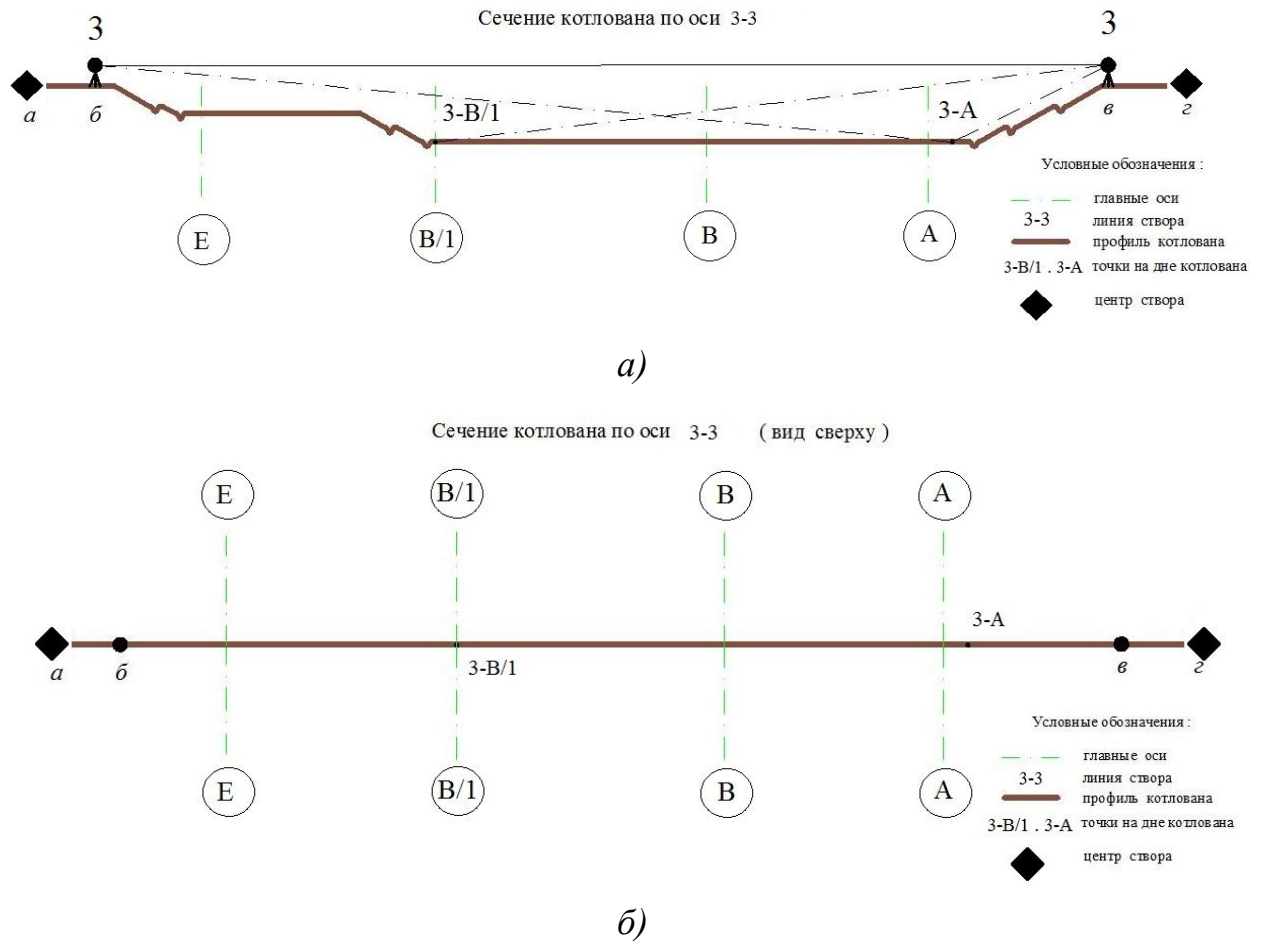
Схема передачи осей: а) вид в разрезе; б) вид сверху
